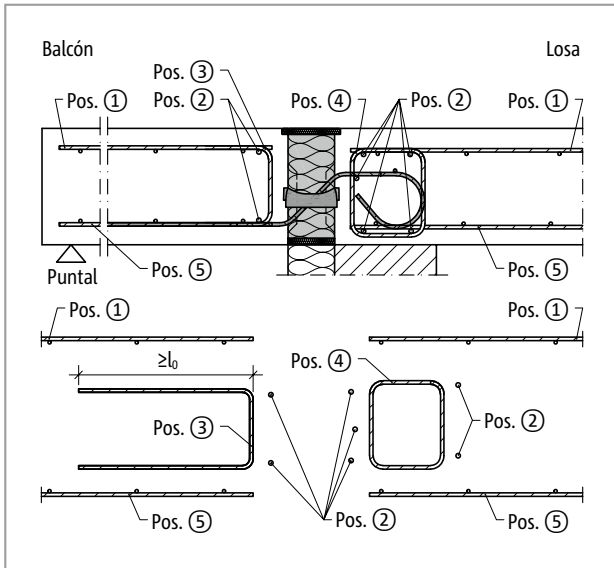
Schöck Isokorb® T tipo Q-V1 hasta Q-V5: Armadura in situ
